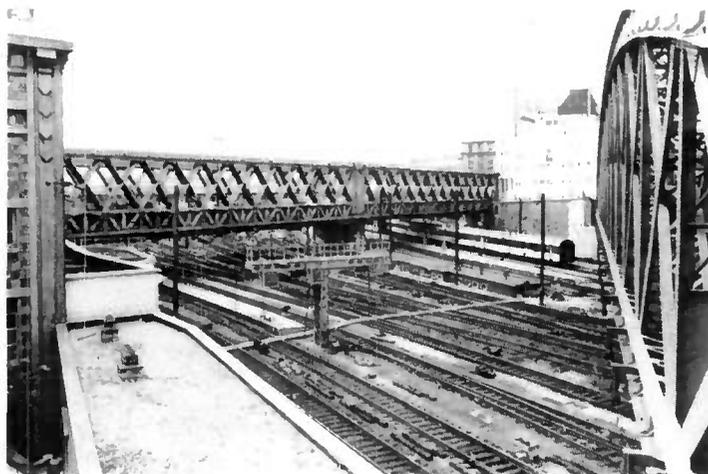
Pont à poutres-treillis de hauteur constante (DREIF-DESRET).
